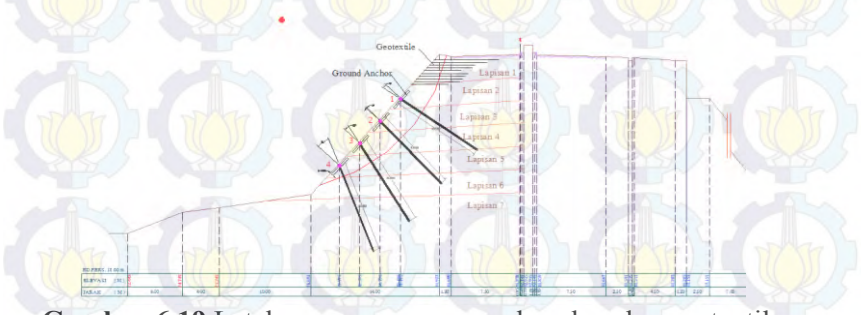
Letak pemasangan ground anchor dan geotextile pada STA. 9+100
